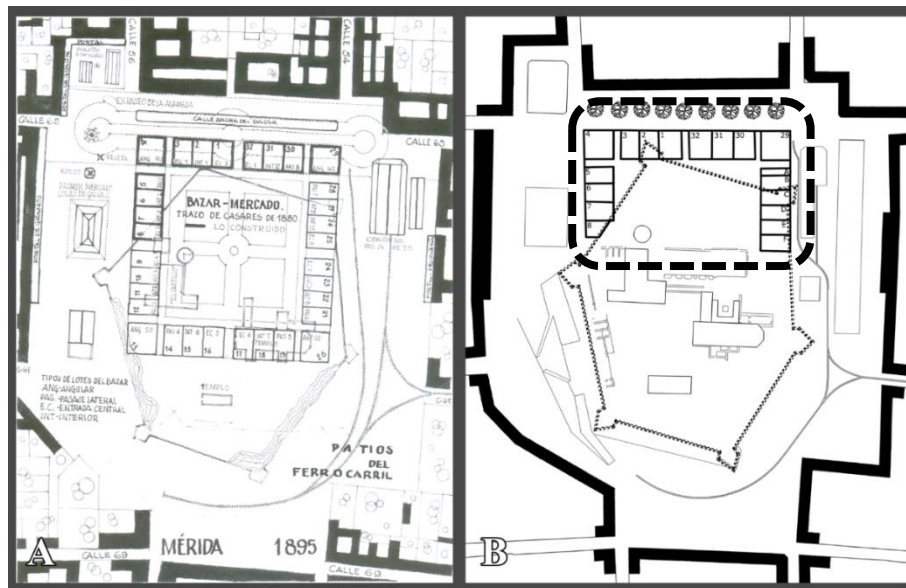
A= Hipótesis del Proyecto Bazar-Mercado sobre las ruinas de la ex –Ciudadela de San Benito y B= Lotes de las tres etapas que se construyeron. Plano A elaborado por Espadas (2010) y plano B elaborado por el autor.
